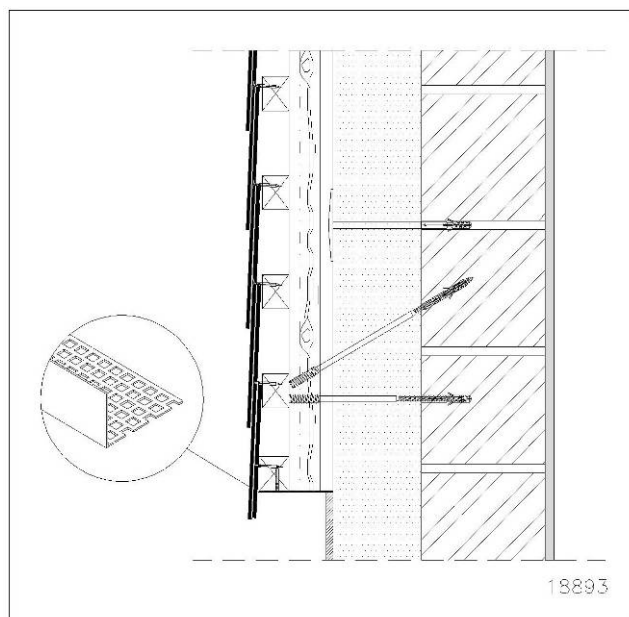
Onderrand - voorzetgevel – verticale doorsnede
